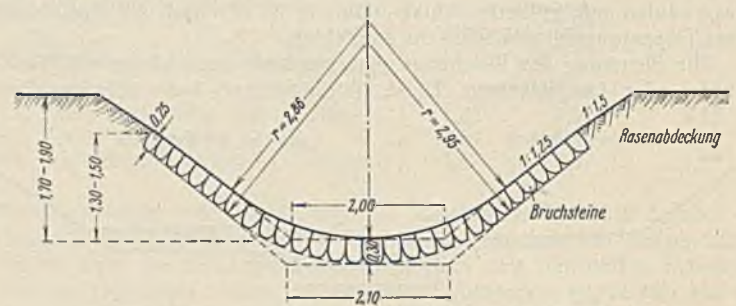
Schnitt durch den Hammermühlbach-Flutkanal, ursprüngliche Ausführung (Kulturbauamt Deggendorf).
